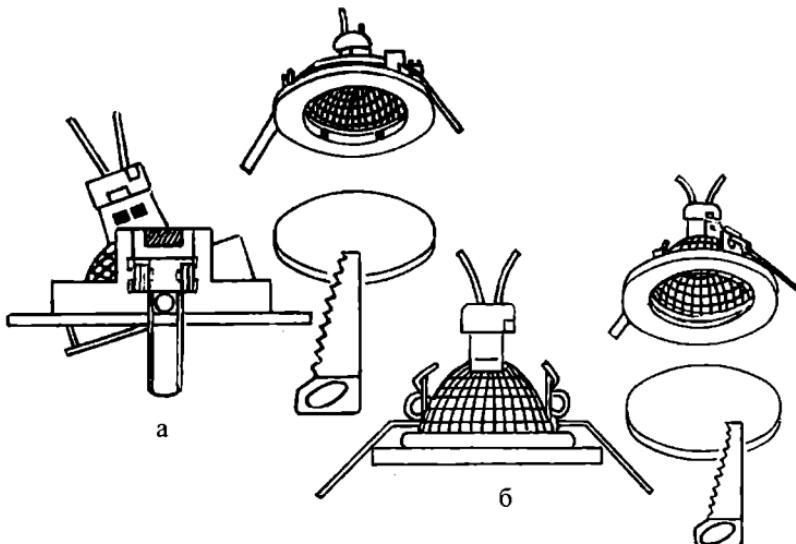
Типовые конструкции точечных светильников под галогенную лампу: а — поворотный; б — неповоротный
